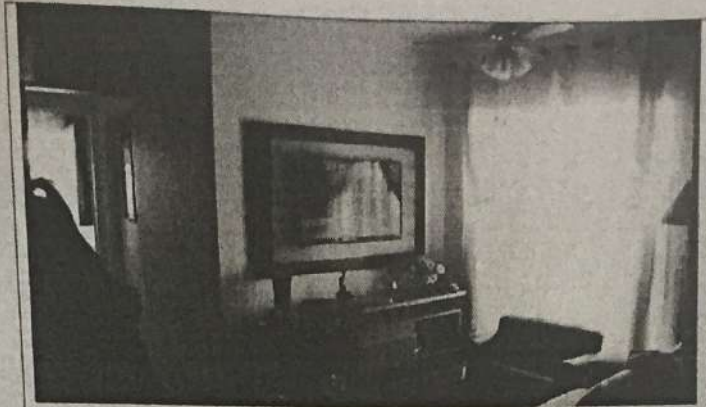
Detalhe da Sala de Estar do Apartamento Nº 146. Nota-se seu estado de conservação e os diversos materiais de acabamento e construção.
